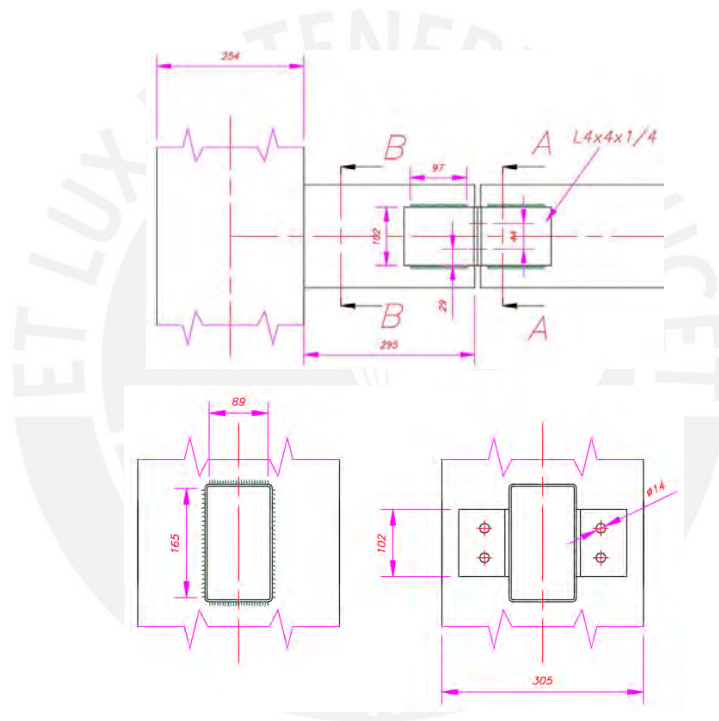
Conexión viga columna-Propuesta N°2-plano longitudinal
